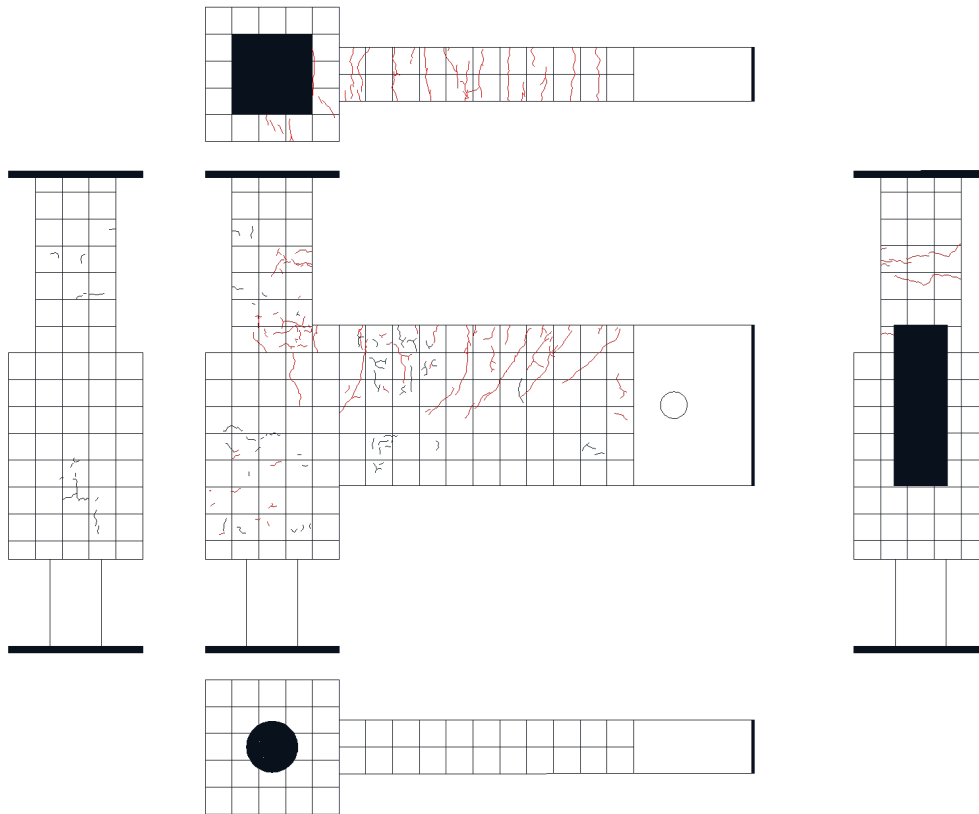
試験体 D-1 ひび割れ状況 (3Cycle)
